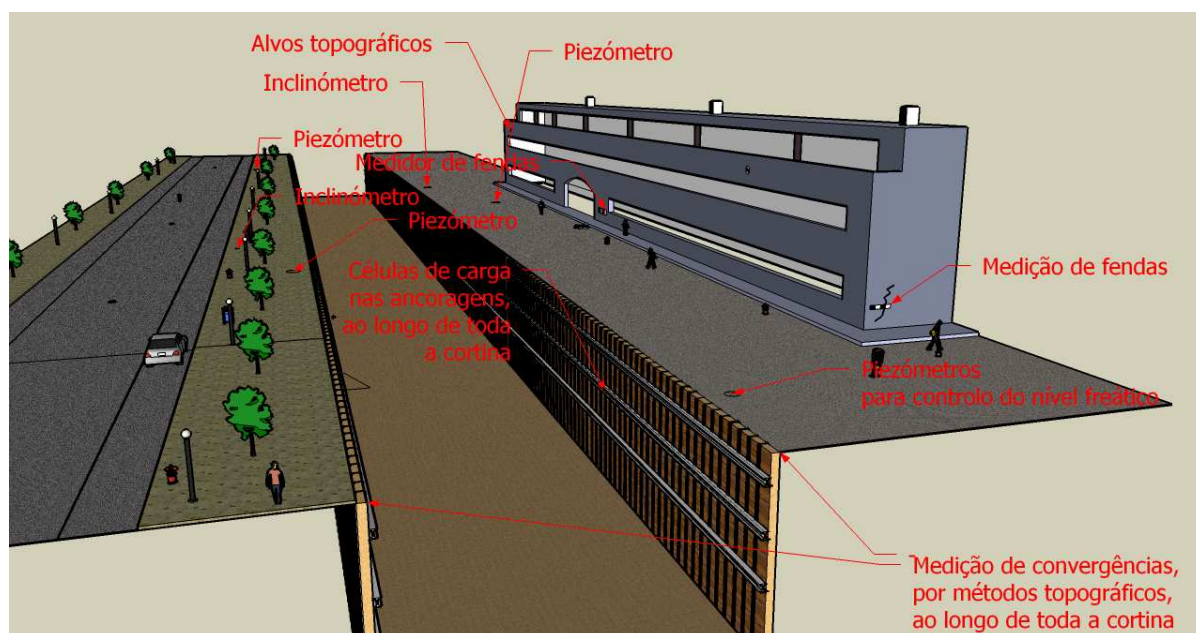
Desenho esquemático da colocação da instrumentação
